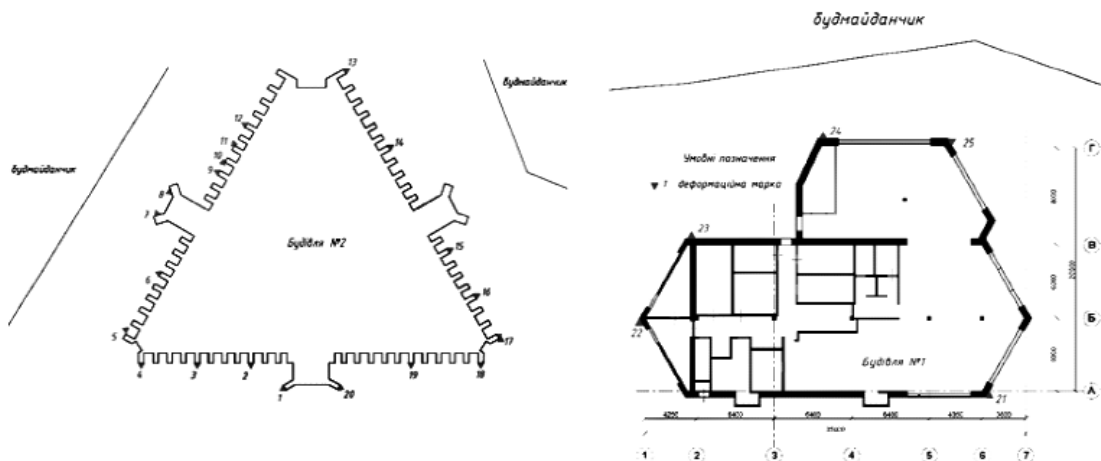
Схеми розташування деформацій на будівлях прилеглої існуючої забудови
